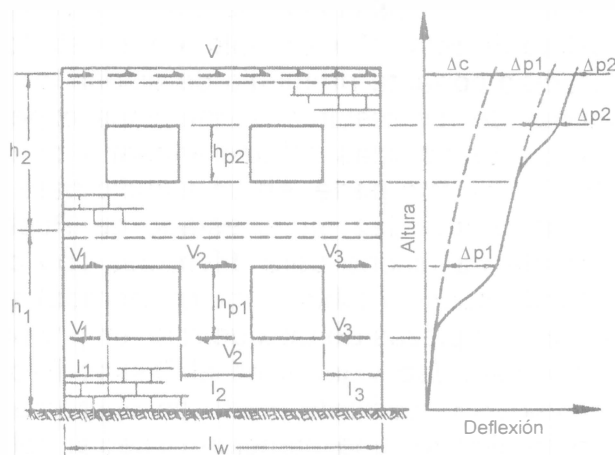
Deformaciones debidas a fuerzas laterales en una estructura de mampostería con aberturas (Paulay and Priestley, 1992).
